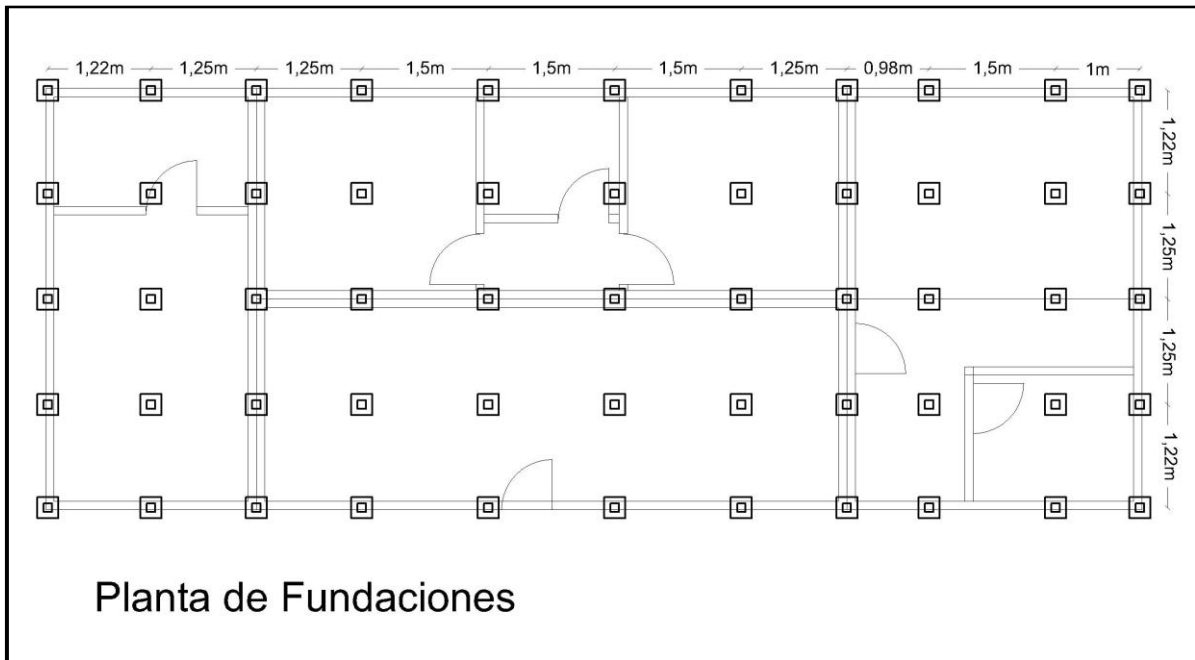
Plano detalle de apoyos. Elaboración propia.
